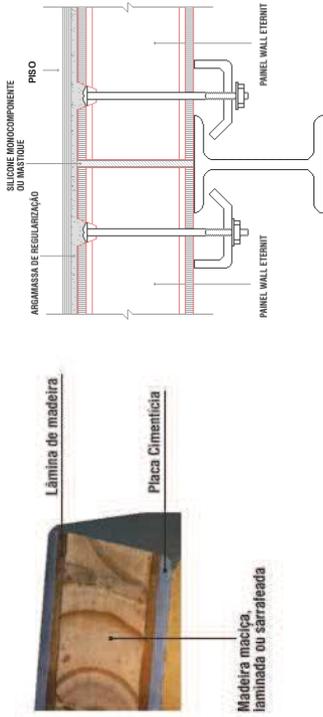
Esquema ilustrativo do Panel Wall, Eternit.
